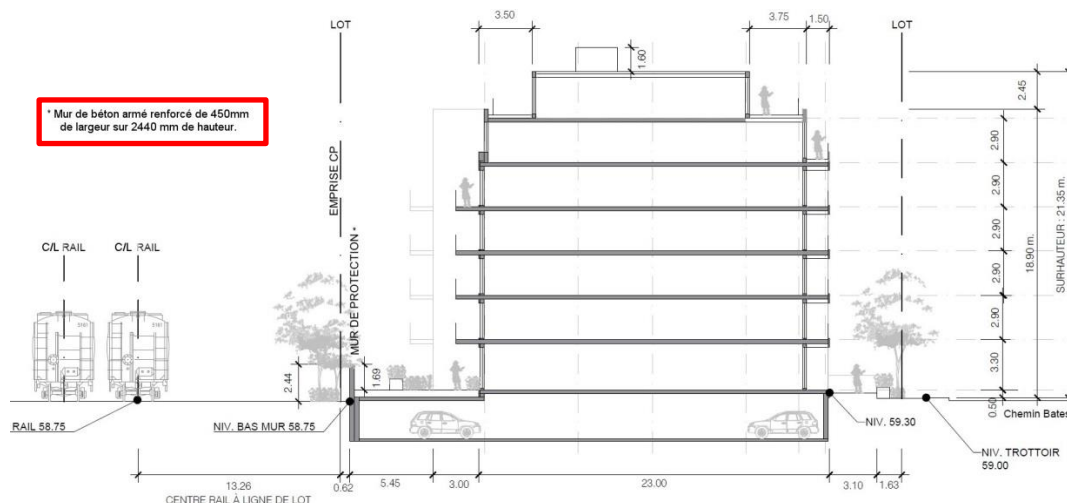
Mur structural de protection de 2,44 mètres (8'-0") minimum de hauteur en béton armé.
